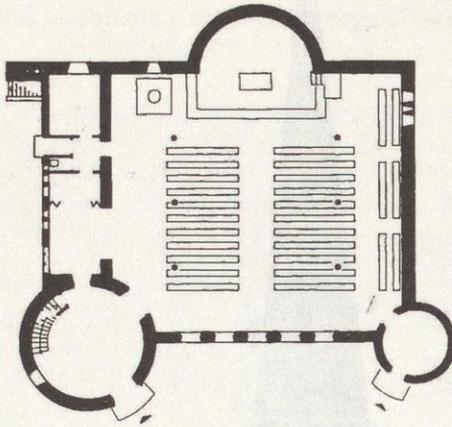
Münster, Kirche zum Evangelisten Lukas, Grundriss (nicht in allen Details realisiert)
